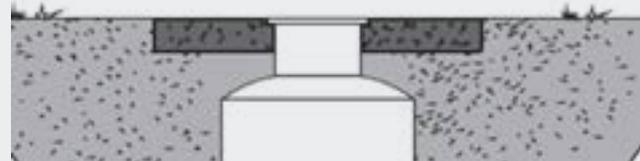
Pumpstation ohne Asphaltierung mit Betonring und verkehrsgerechter Abdeckung
